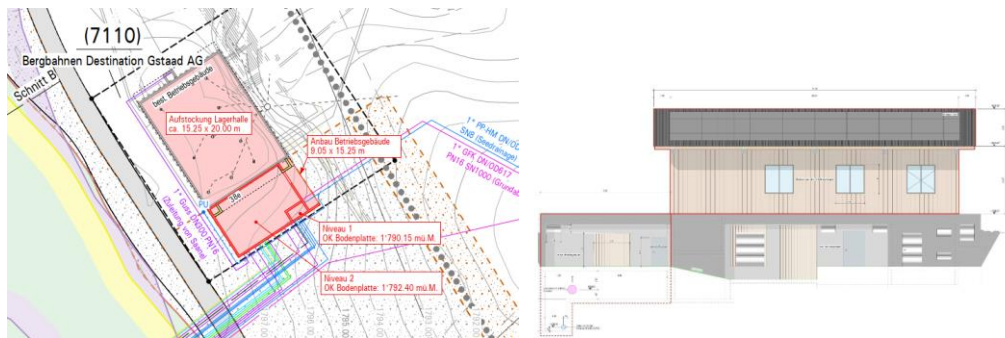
Aufstreckung und Anbau des bestehenden Betriebsgebäudes, Ausschnitt Situationsplan und Fassadenansicht Nord-West Baueingabeplan (Quelle: Steiger Ingenieure + Planer AG)
